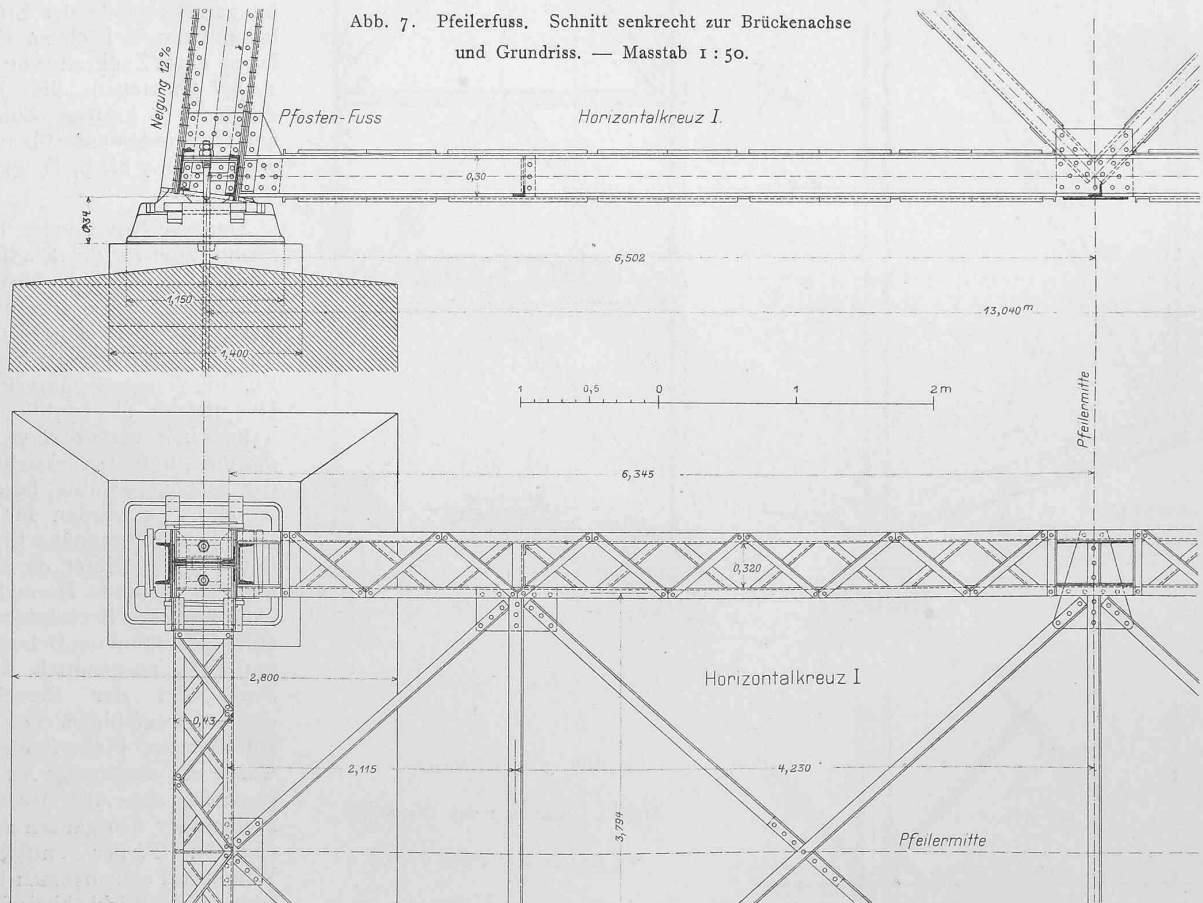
Pfeilerfuss, Schnitt senkrecht zur Brückenachse und Grundriss. — Masstab 1 : 50.
